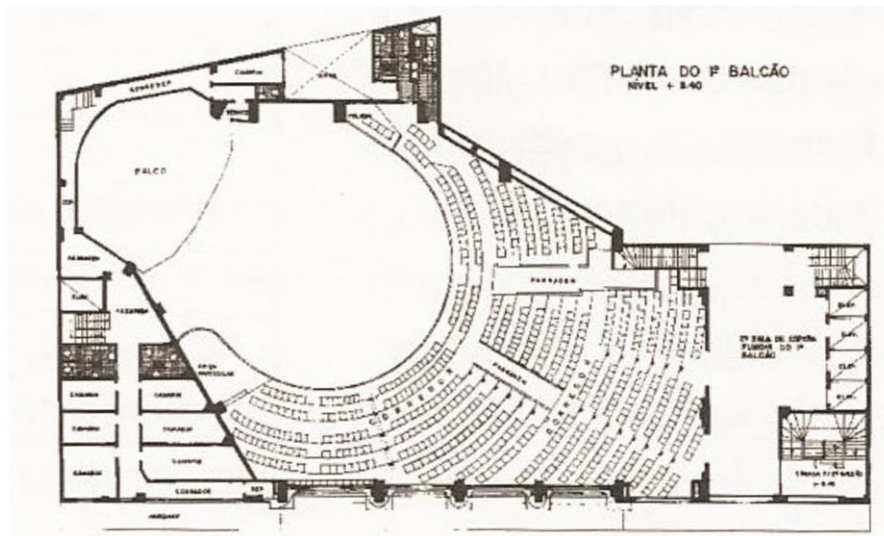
“Palácio” – Planta Baixa do primeiro balcão do Cine Rex. Fonte: FURQUIM, 2000.
